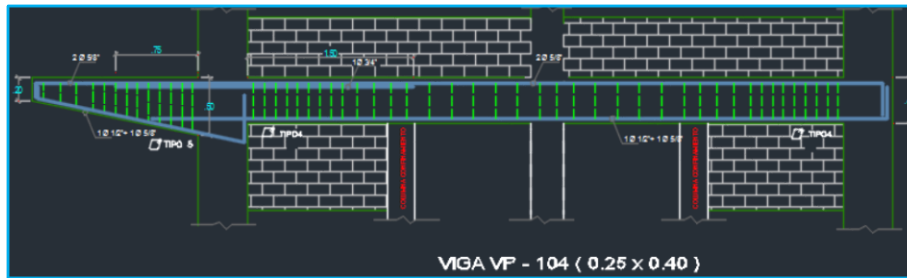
Detalle de las dimensiones de la viga VP-104 y el acero de refuerzo
